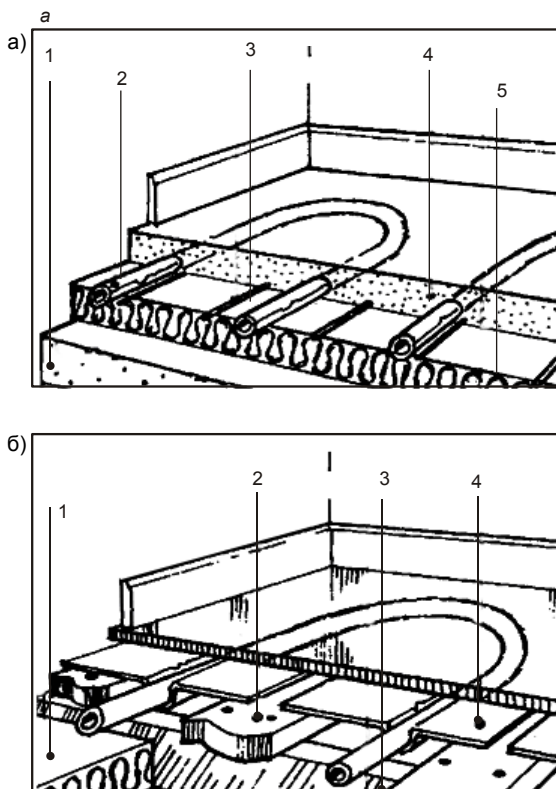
Укладка теплого пола: а — стандартный вариант с бетонной стяжкой:
